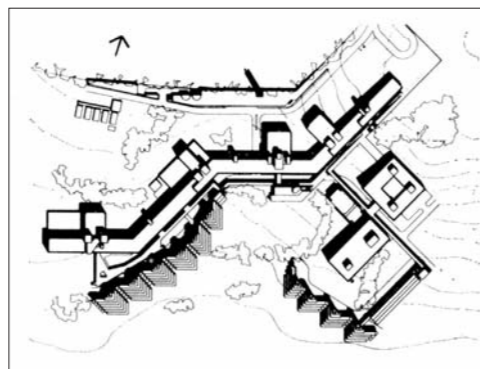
LASDUN, Denys - Campus da Universidade de East Anglia, Norwich, 1962. Planta geral.
